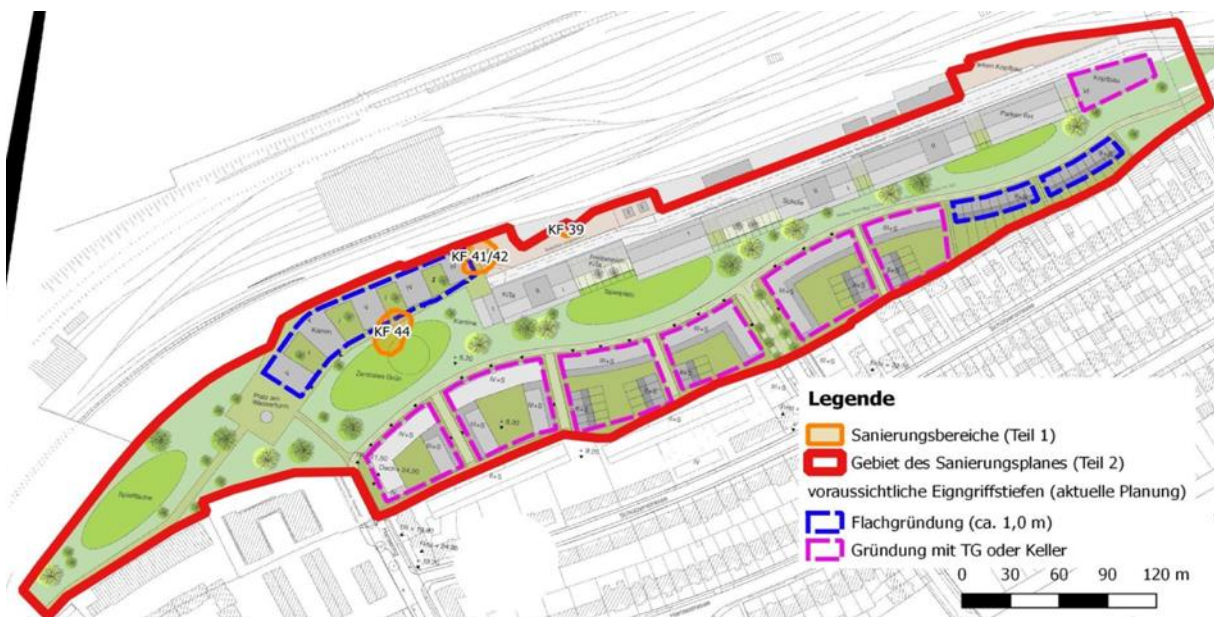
Sanierungsplan mit Sanierungsbereichen (Quelle: M & P 2020)
